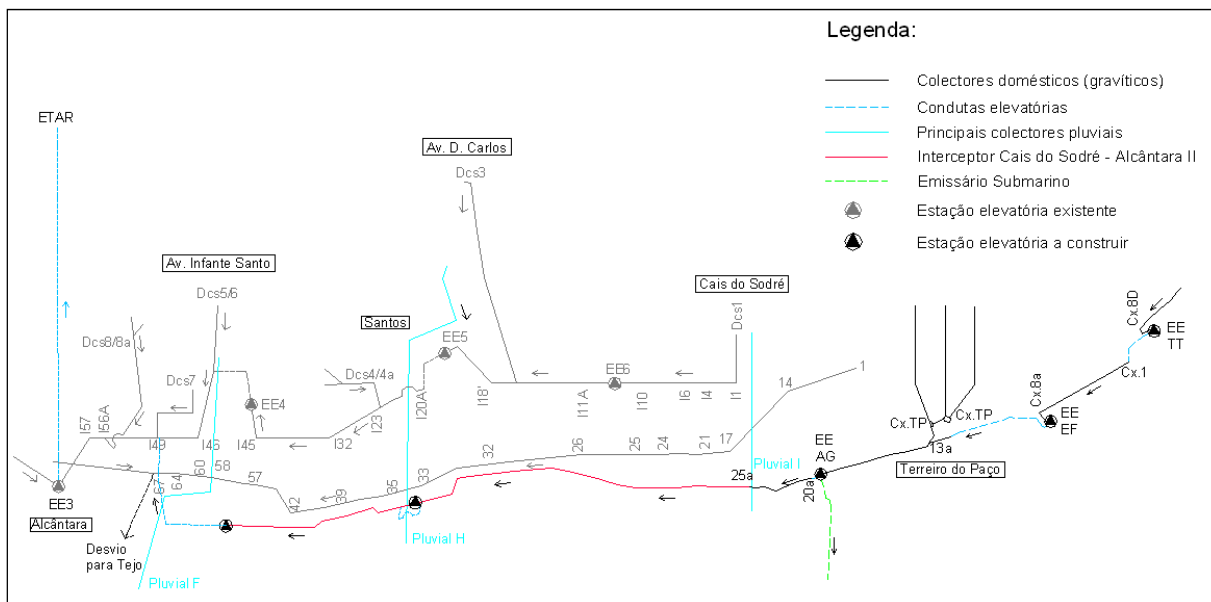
Representação esquemática, em planta, do futuro sistema interceptor Terreiro do Paço - Alcântara
